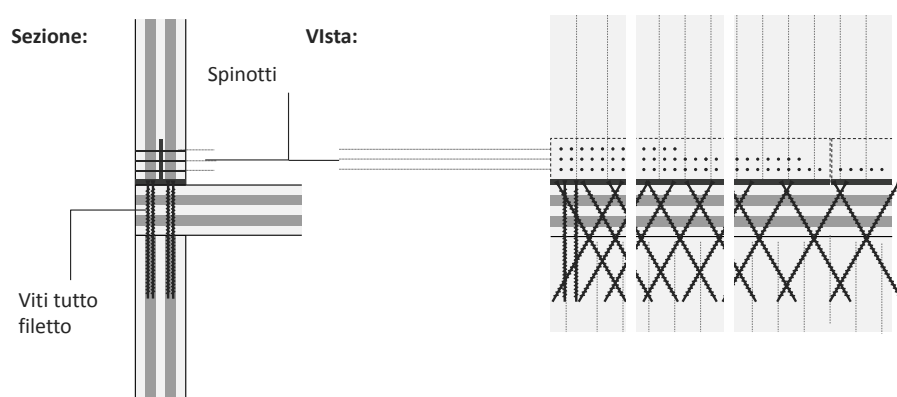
collegamento per prestazioni elevate parete-soletta-parete XLAM con staffe metalliche a T, viti a tutto filetto e spinotti
